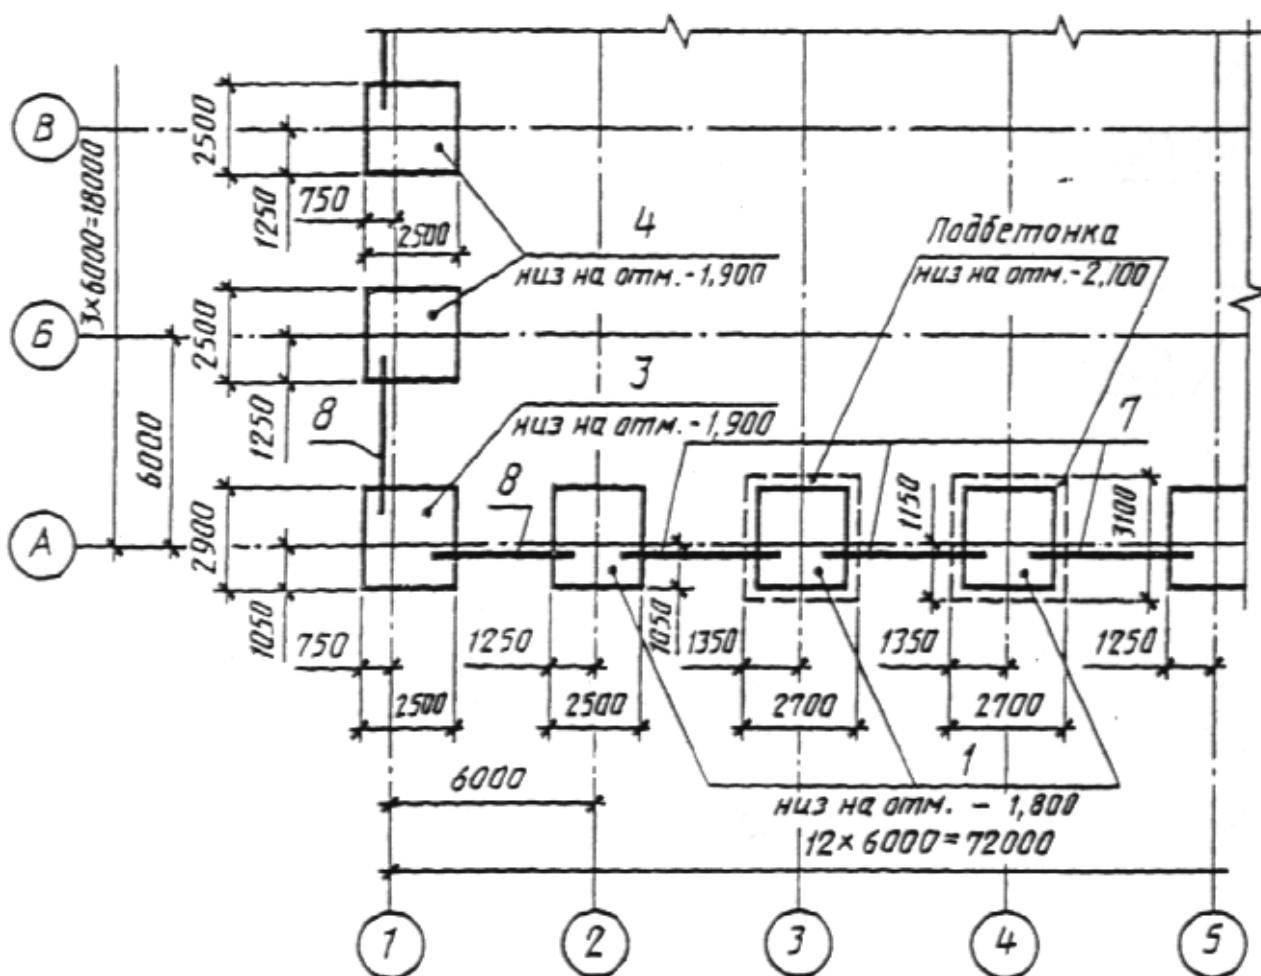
Схема расположения элементов фундаментов и фунда. балок
